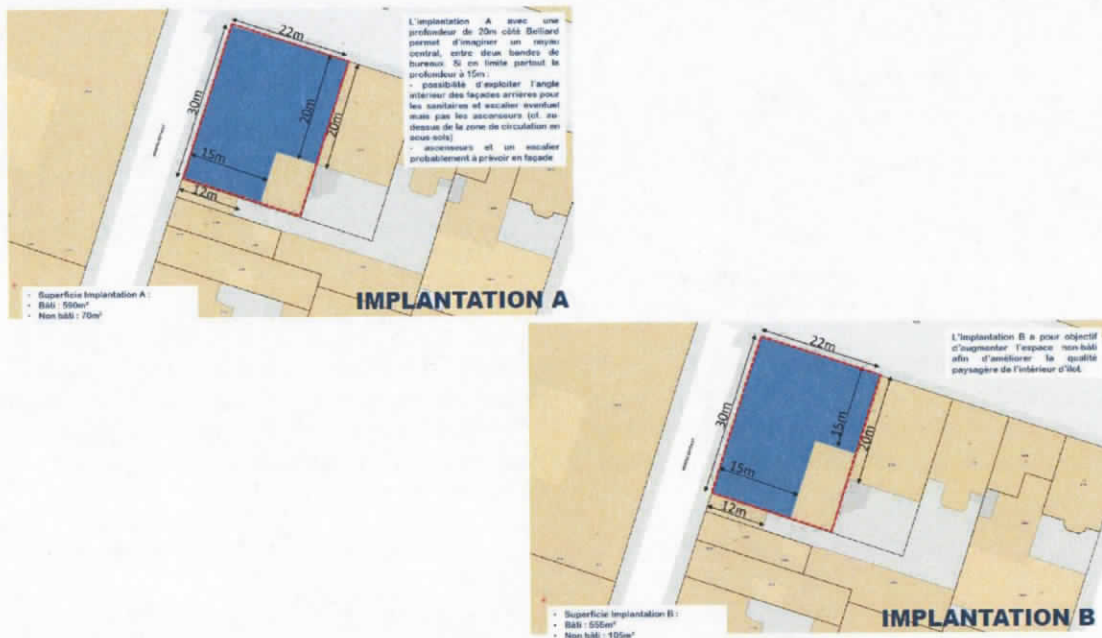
Propositions d'implantation (Source : A&B 2016)
